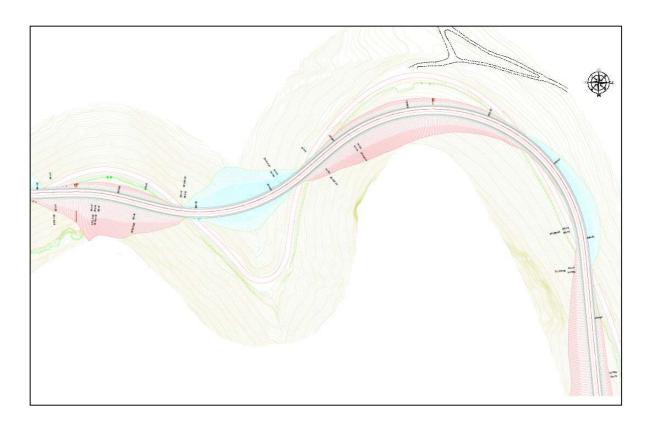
Traazado en planta de un tramo de la Alternativa 2.
